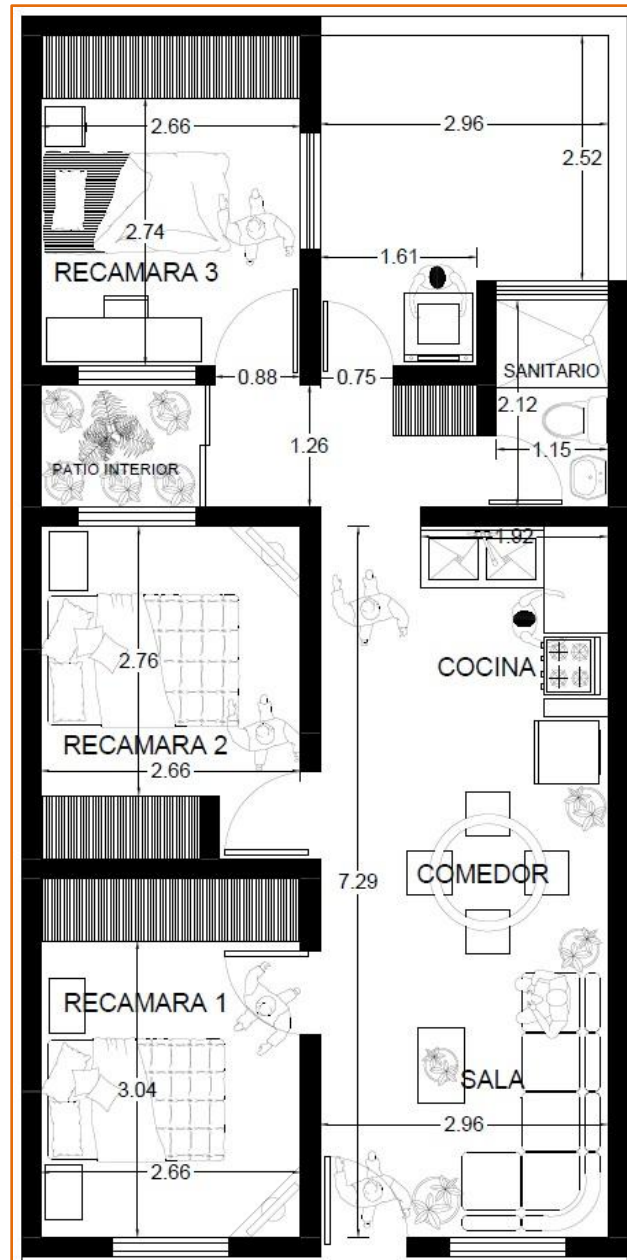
Plano de propuesta arquitectónica para caso de estudio 1.
